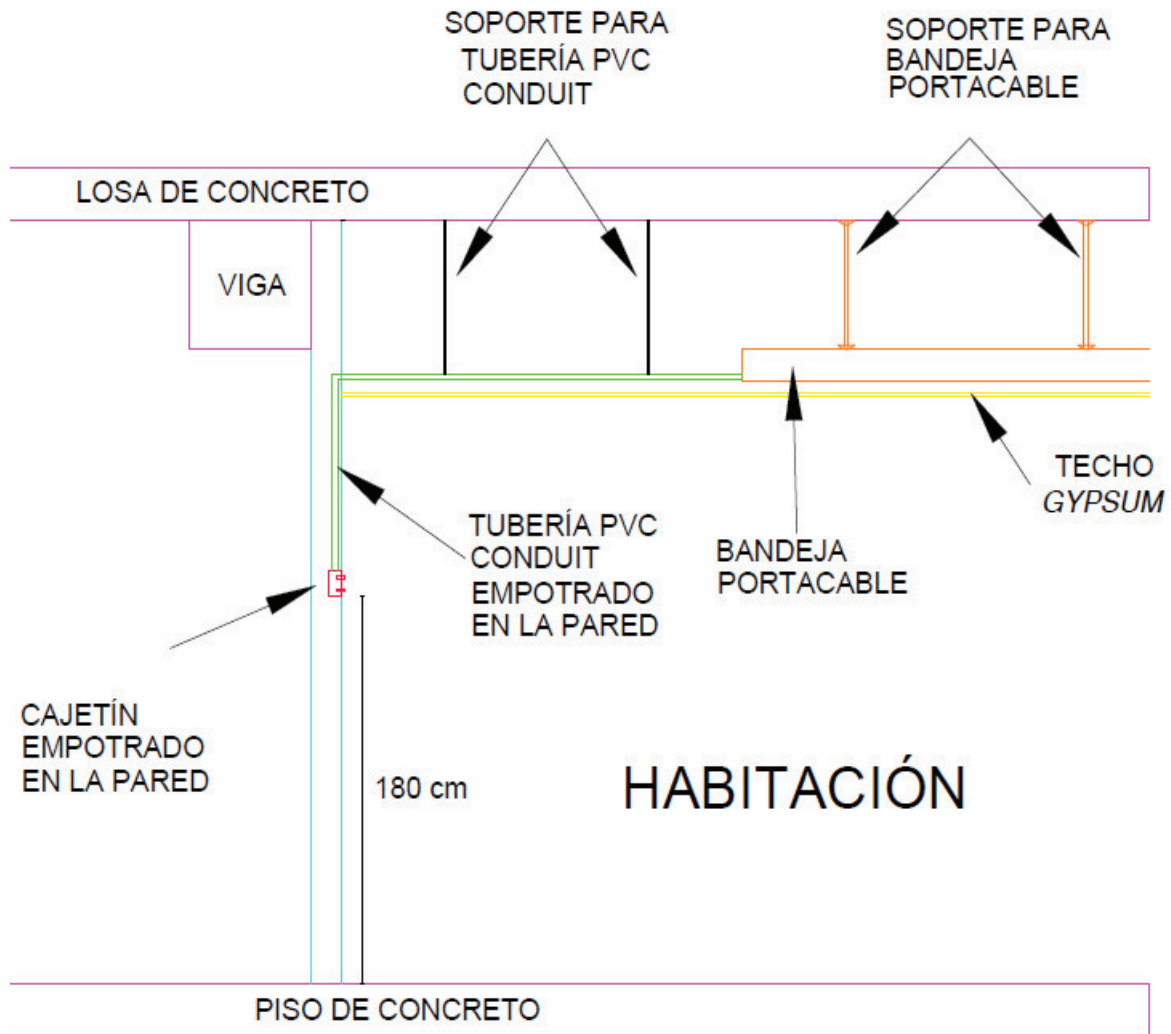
Detalle de tubería en el subsistema de cableado horizontal para video (TV).
